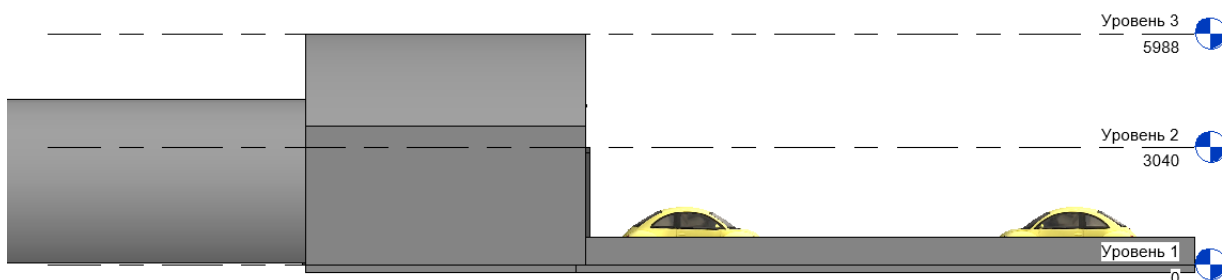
Архитектурно-планировочное решение (фасад - западный)
